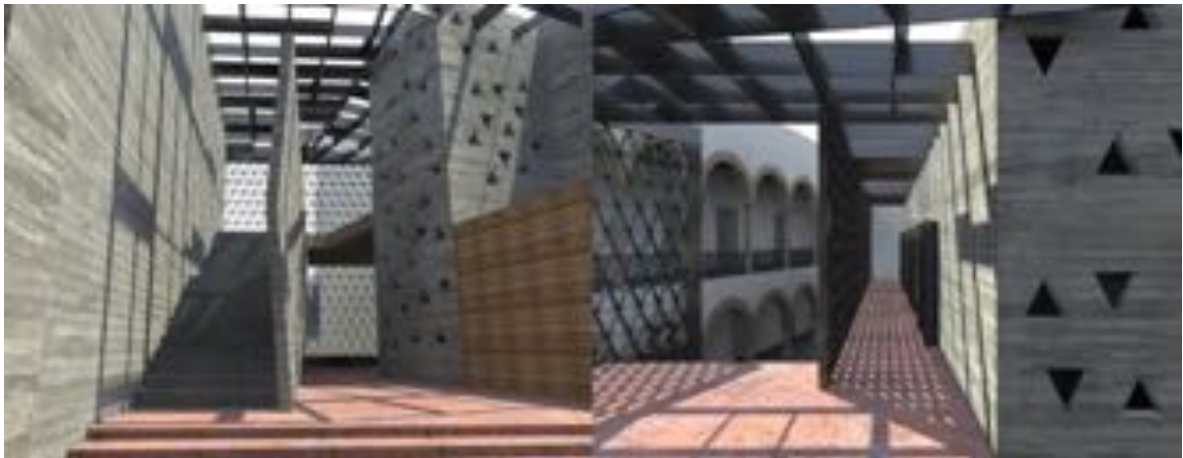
y 72. Vistas de la propuesta para el nuevo conjunto de habitaciones. Vestíbulo principal y sistemas constructivos: muros de carga y cubierta reticular.
